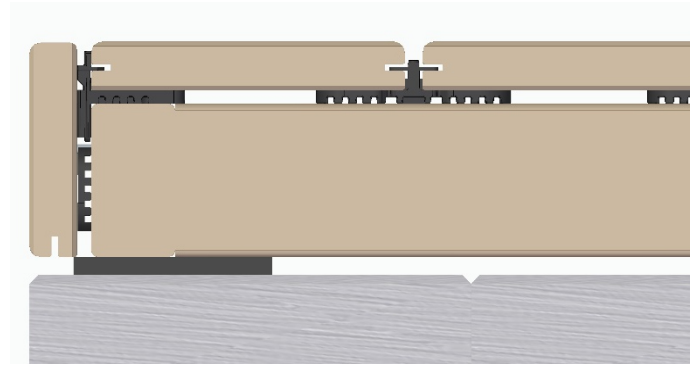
Unterhalb der Blende sollte min. 8 mm Luft eingeplant werden.
